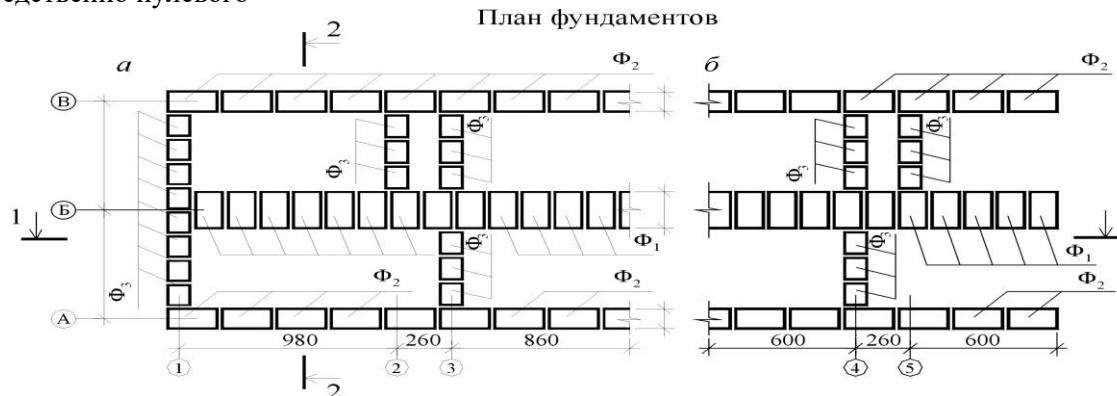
Планы фундаментов и раскладки плит перекрытия над подвалом:
